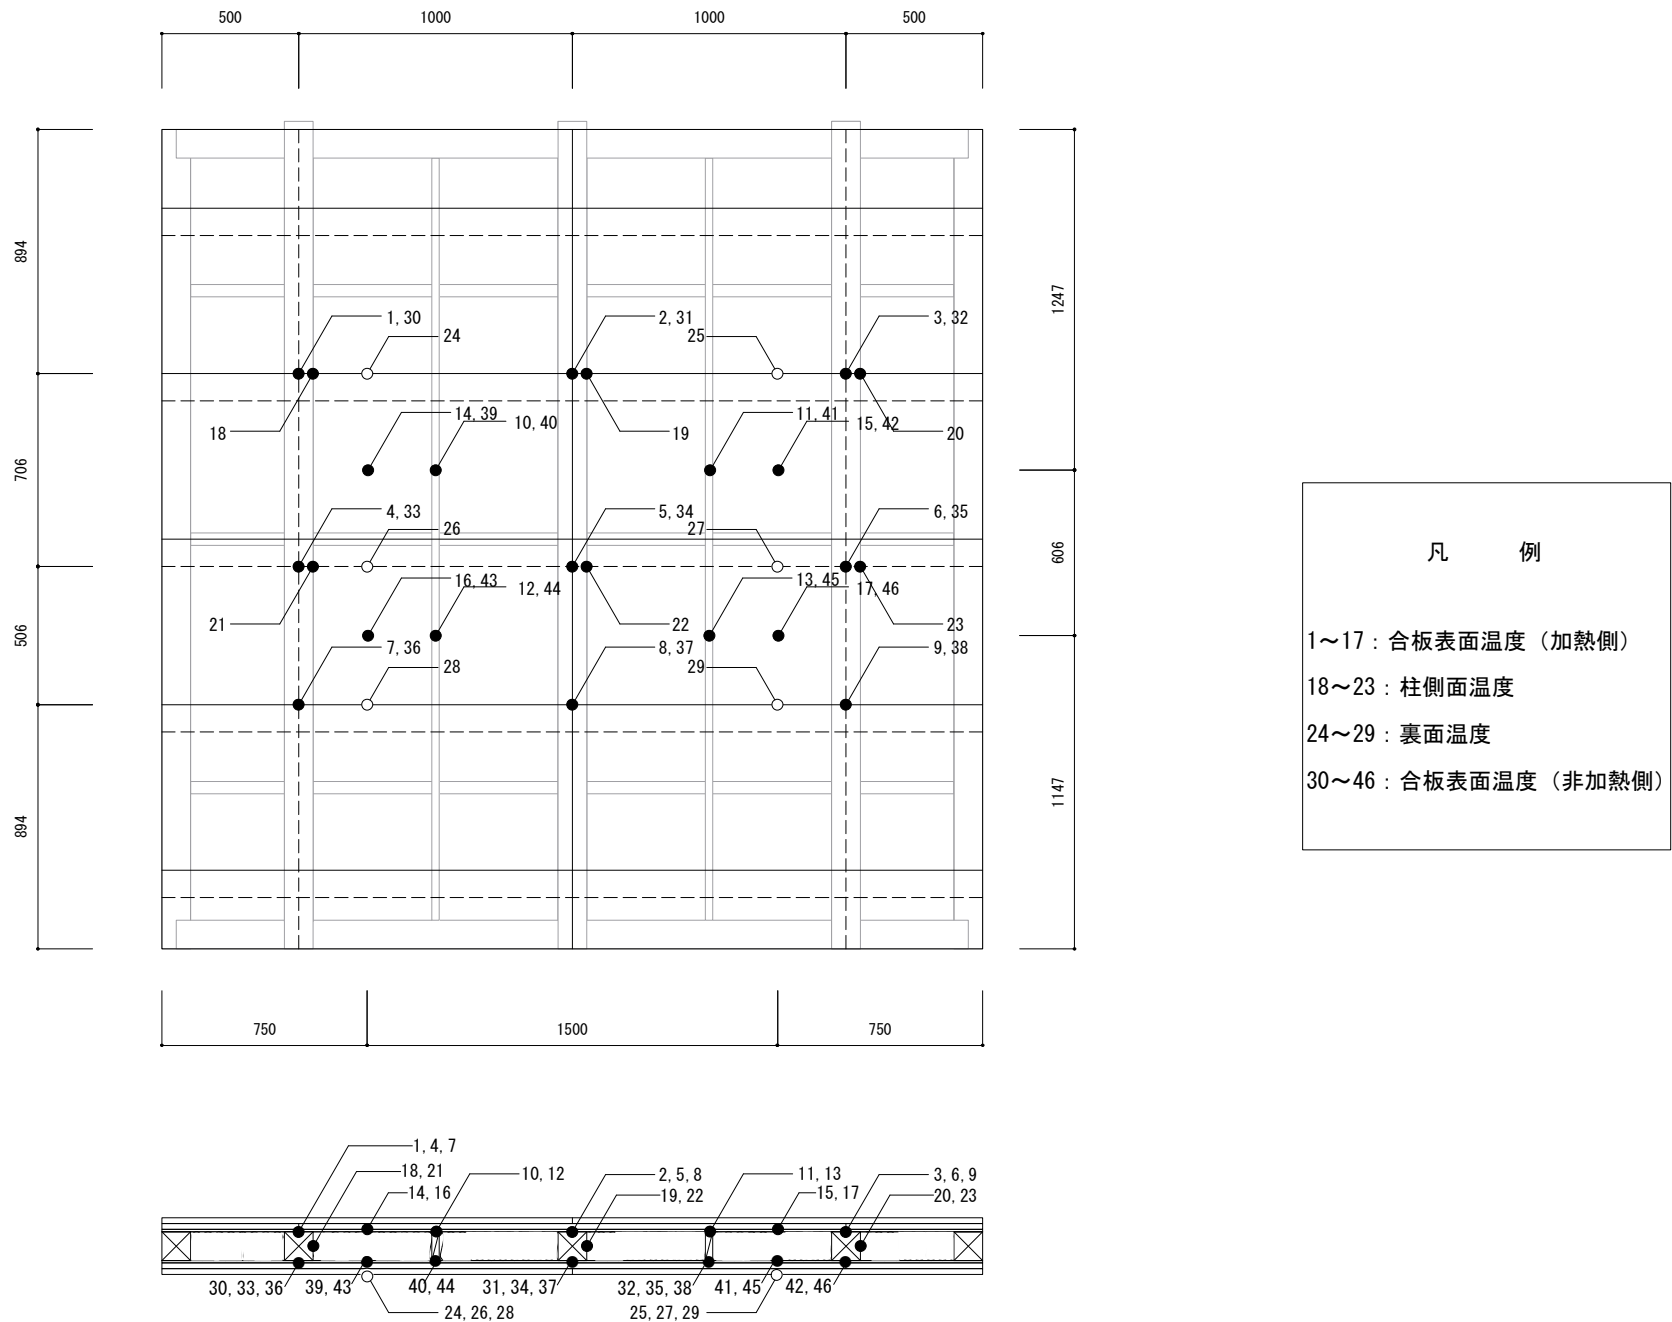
木造壁耐火試験用試験体 熱電対配置図 (寸法 : mm)
